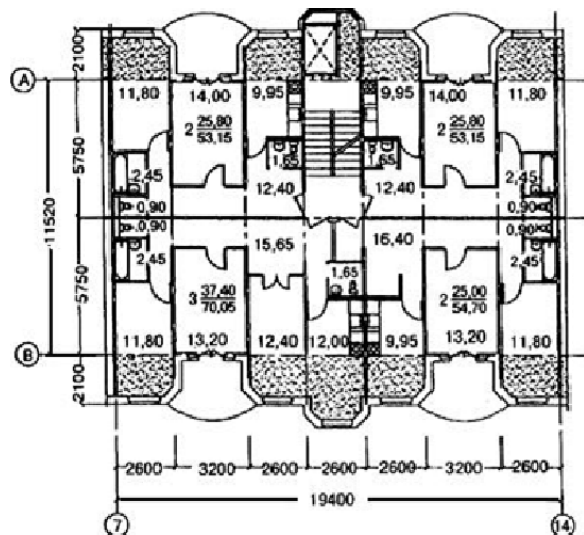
План перепланировки домов серии 1-464: перенос санузлов; увеличение площади кухонь; перепланировка с ликвидацией проходных комнат; демонтаж балконов и наружных стен при шаге 2,6м; пристройка уширений корпусов с лоджиями и лифтовой шахтой; надстройкой двух этажей
